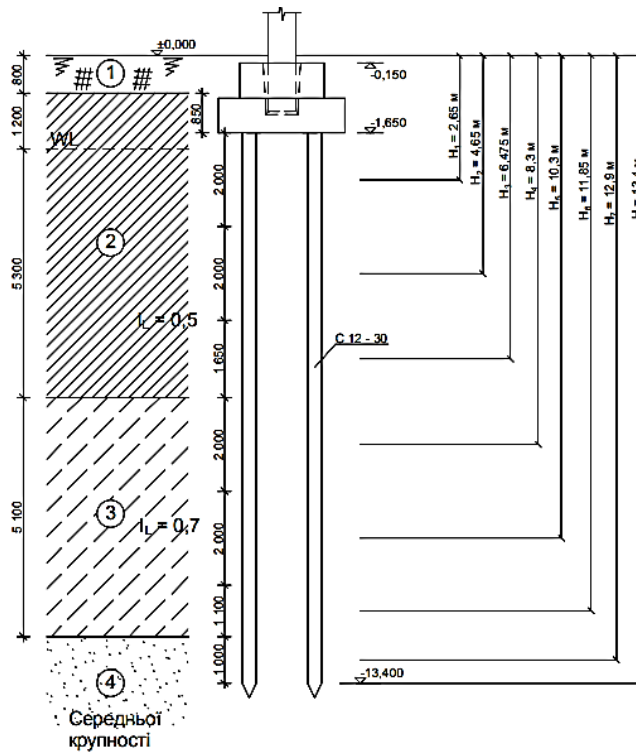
Положення у ґрунті і розрахункова схема фундаменту з забивних паль
